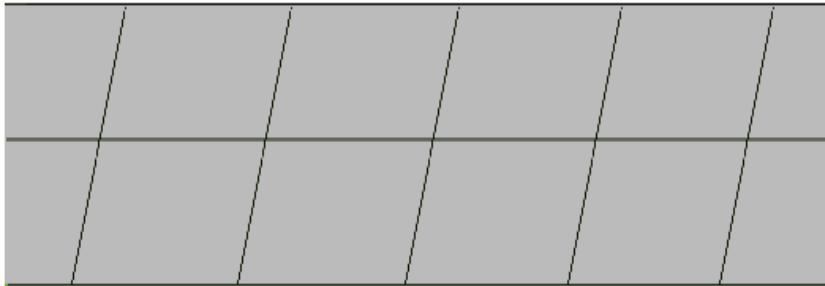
Piso de concreto com juntas transversais inclinadas
